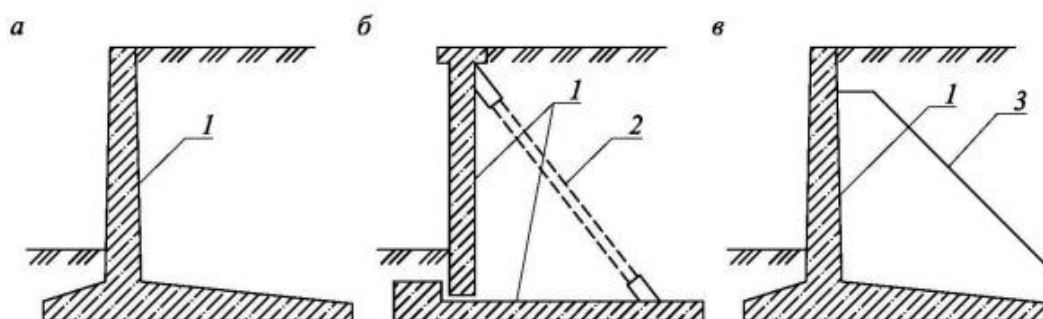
Уголковые подпорные стены: а – консольные; б – с анкерными тягами; в - контрфорсные; 1 – подпорная стена; 2 – тяга; 3 - контрфорс
